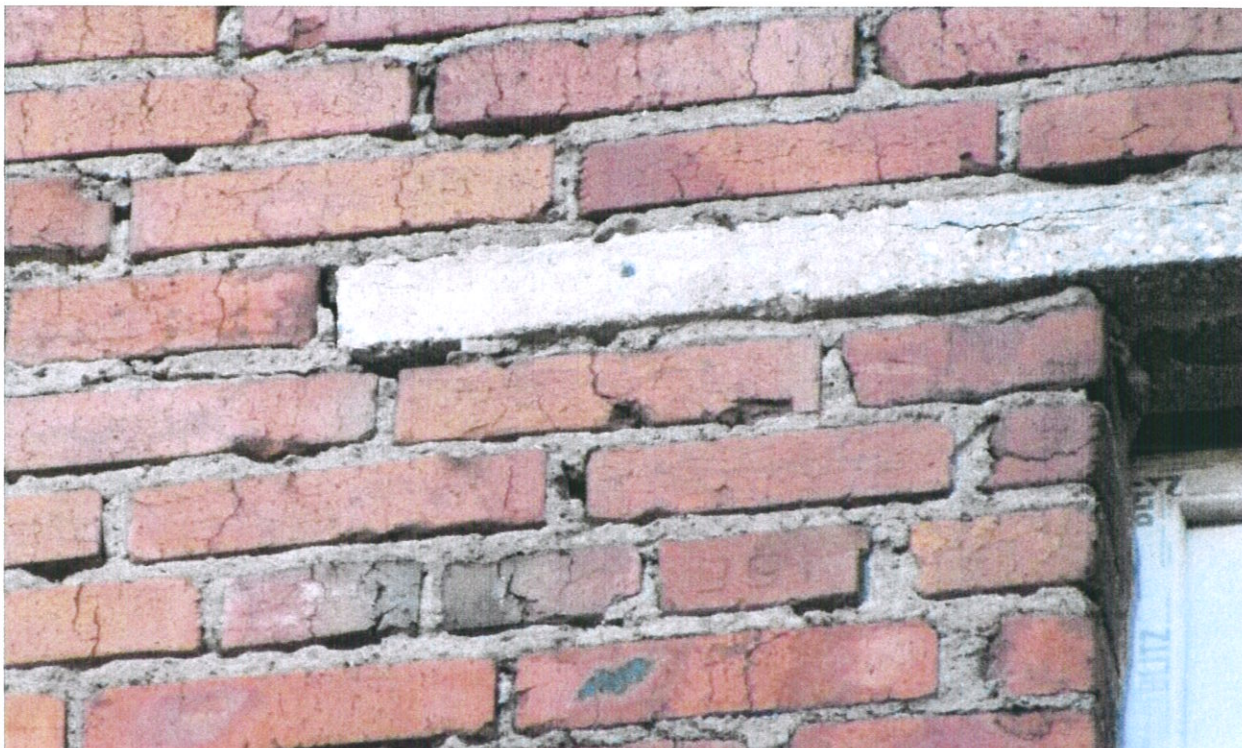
В торце здания железобетонные перемычки оконных проемов потрескались.
